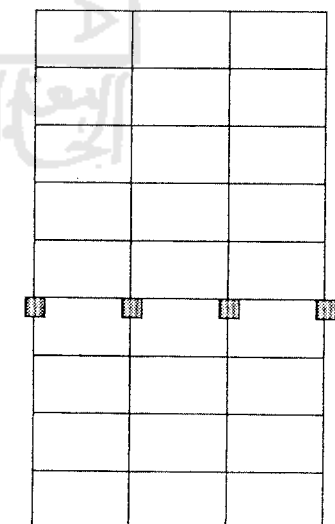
Tingkat 9 lantai ke 1
